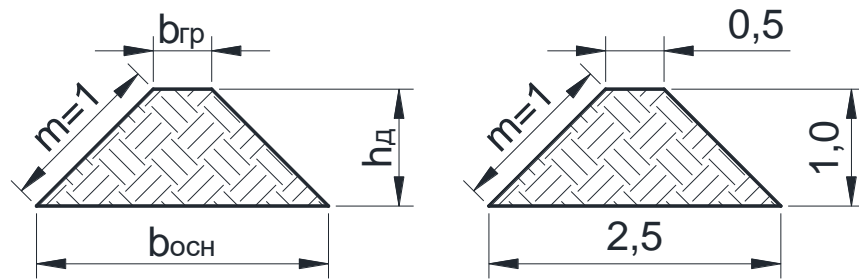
Поперечний переріз ґрунтової дамби обвалування тваринницької ферми (розміри вказані в метрах)
